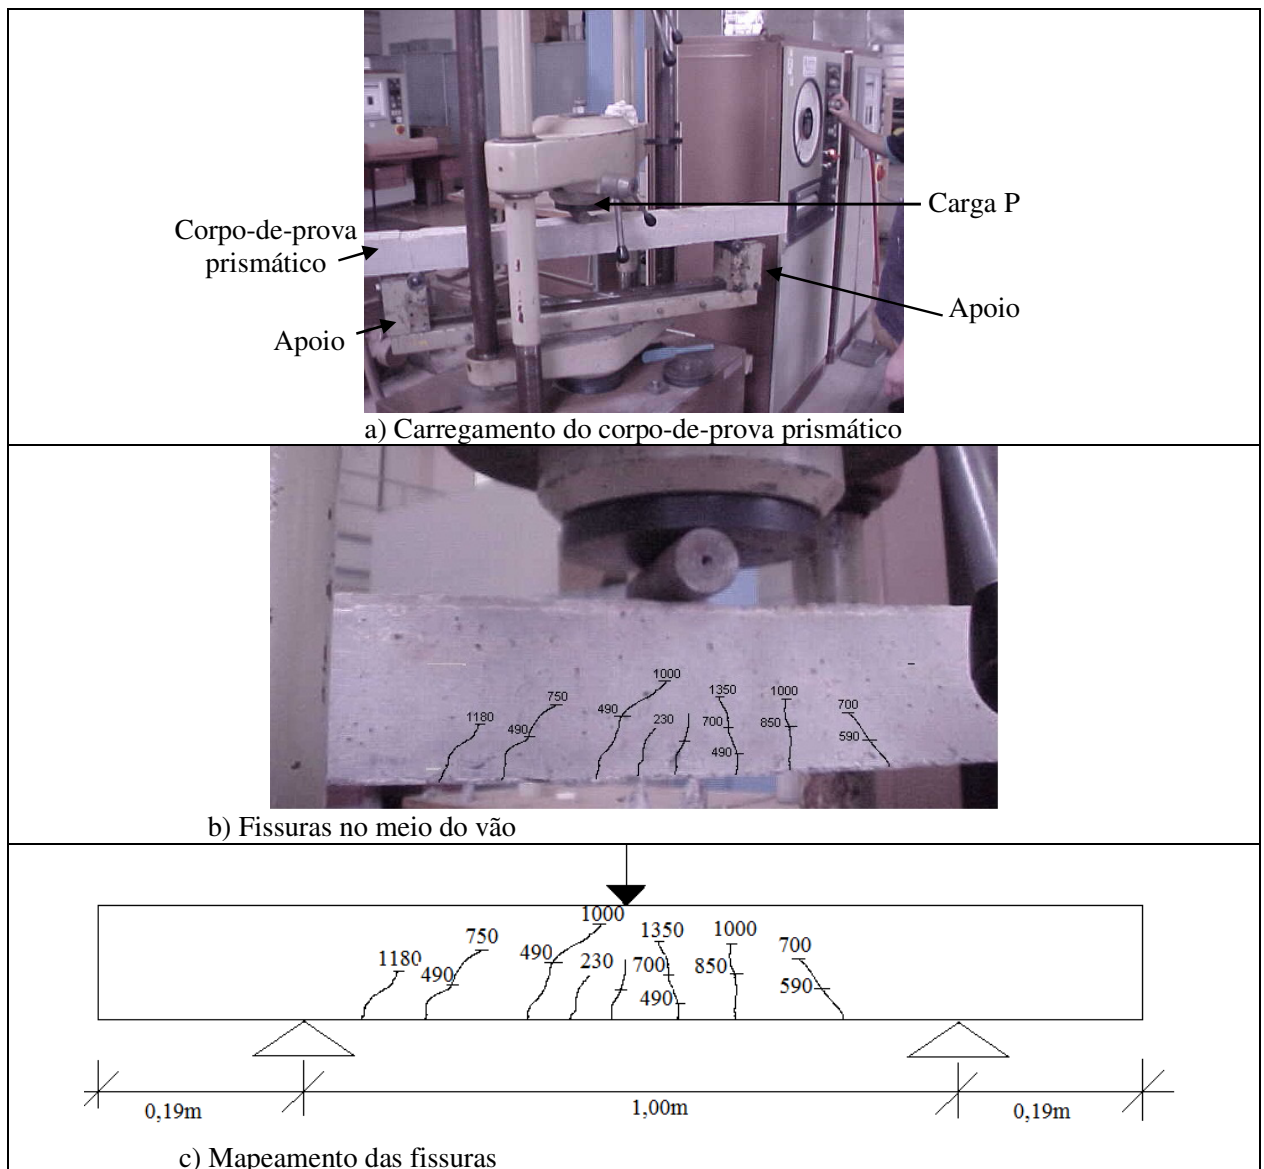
Ensaio no corpo-de-prova prismático piloto.
